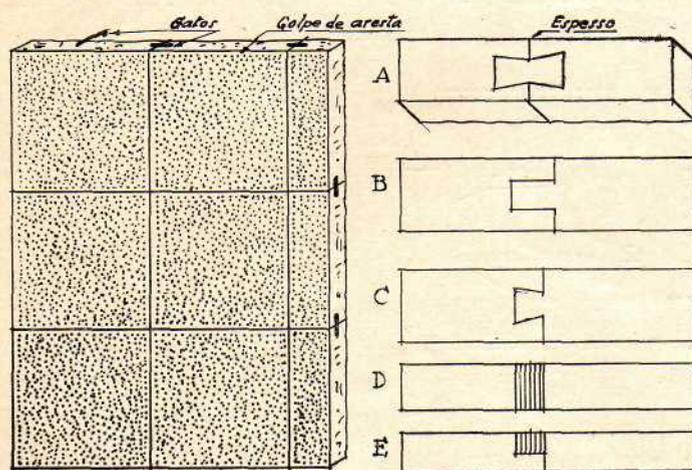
CABEÇAS DE FERRO APARELHADAS E LIGAÇÕES DE PEDRAS
